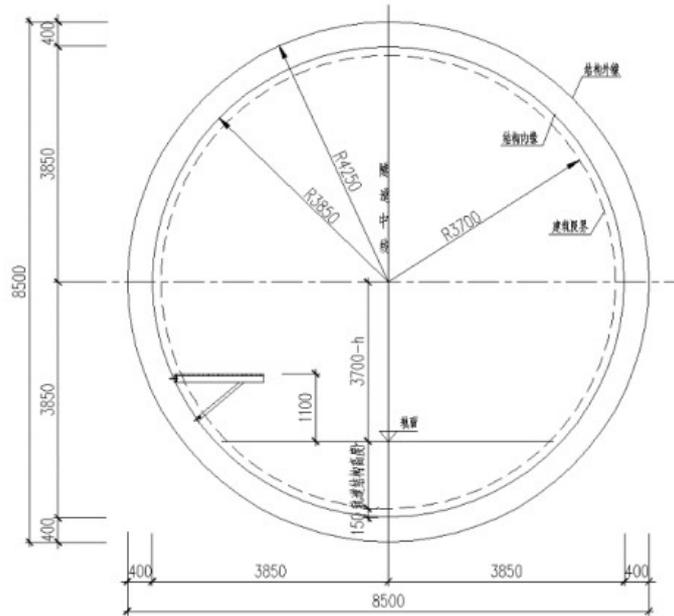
双洞单线盾构隧道横断面图（单位：mm）
